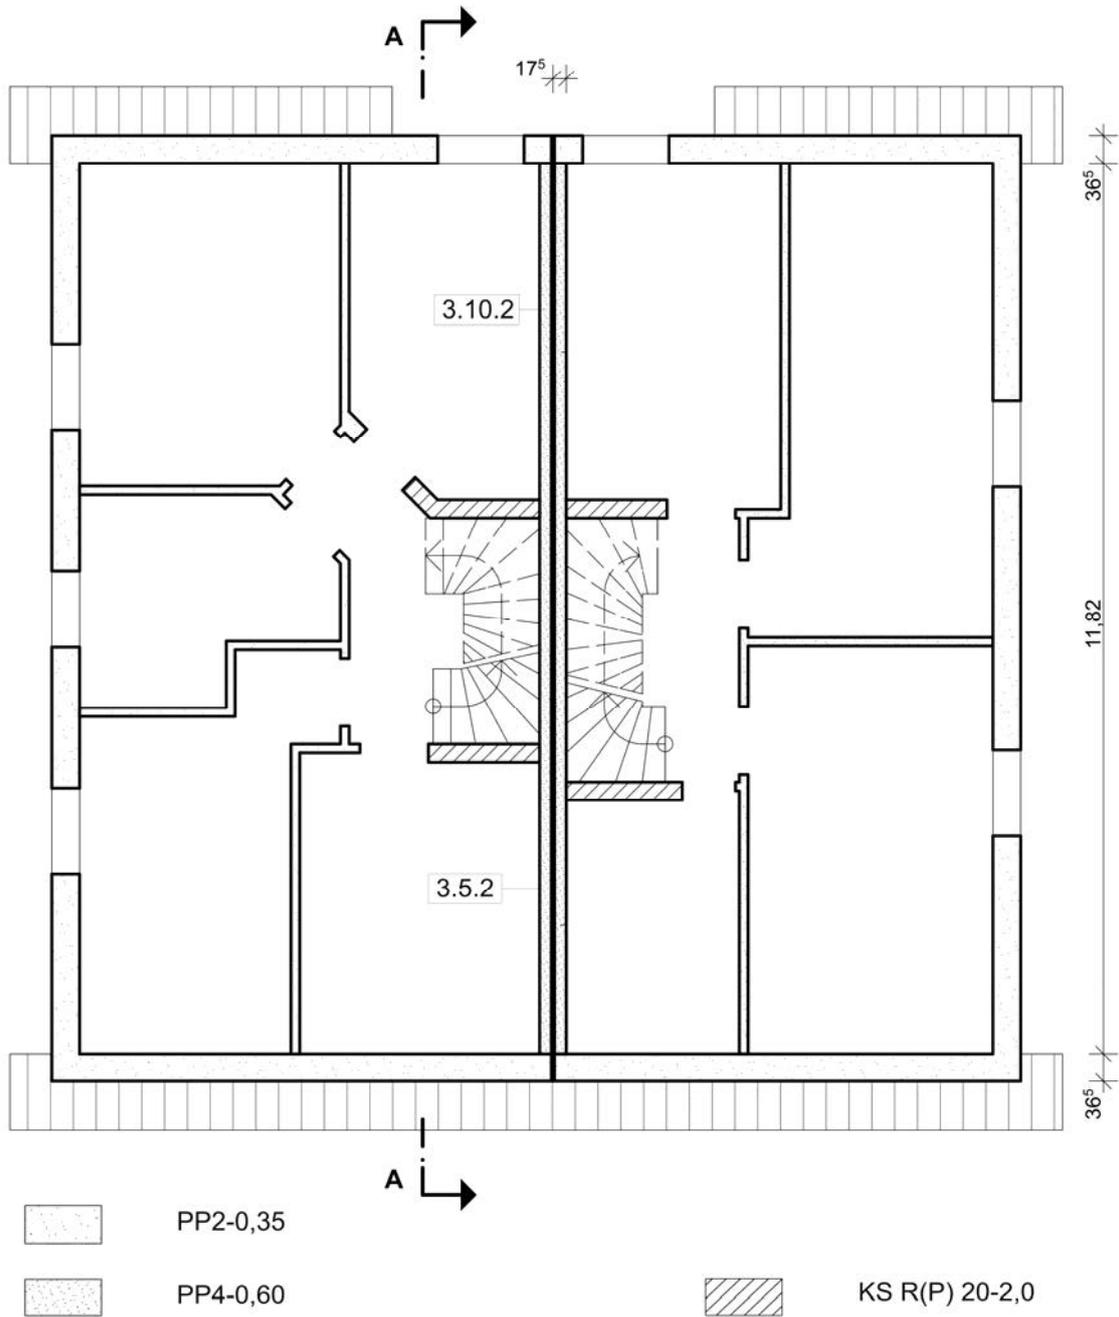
Doppelhaus in Hövelhof, Grundriss Dachgeschoss
